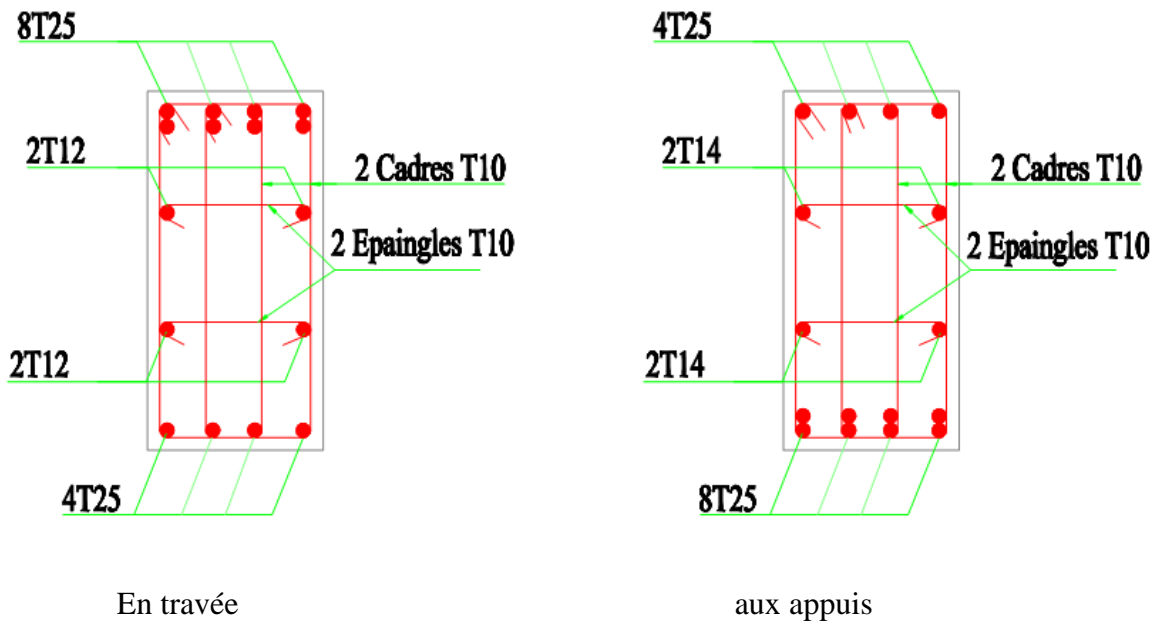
Schéma de ferrailage de la PDR type 2.
